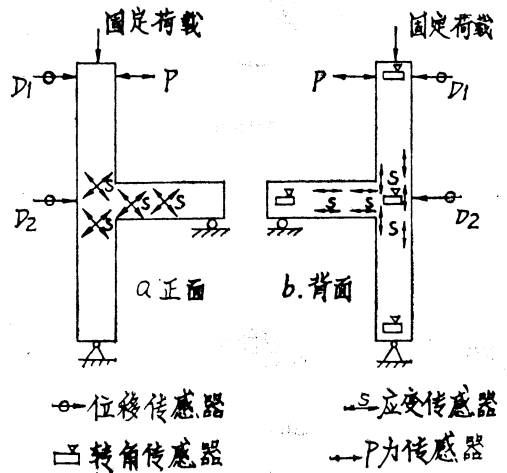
钢筋混凝土框架梁柱结点测点布置示意图。
